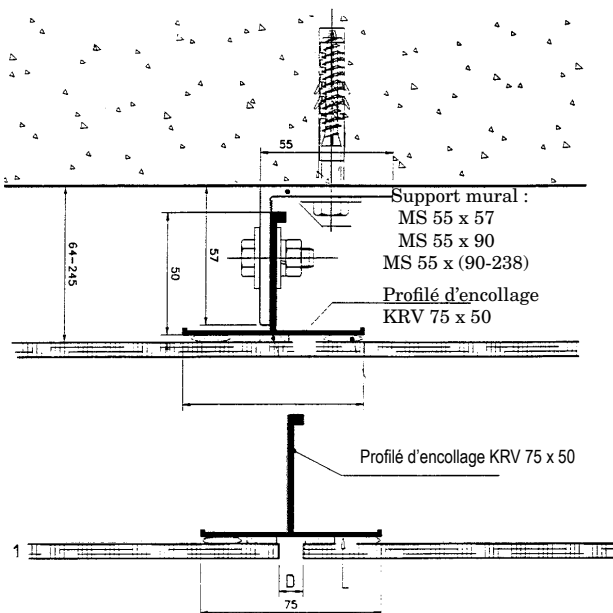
Système de profilés en aluminium de type KRV : coupe horizontale de profilé vertical. Toutes les surfaces d'adhérence collées ou revêtues d'un mastic doivent être traitées avec un primer.
